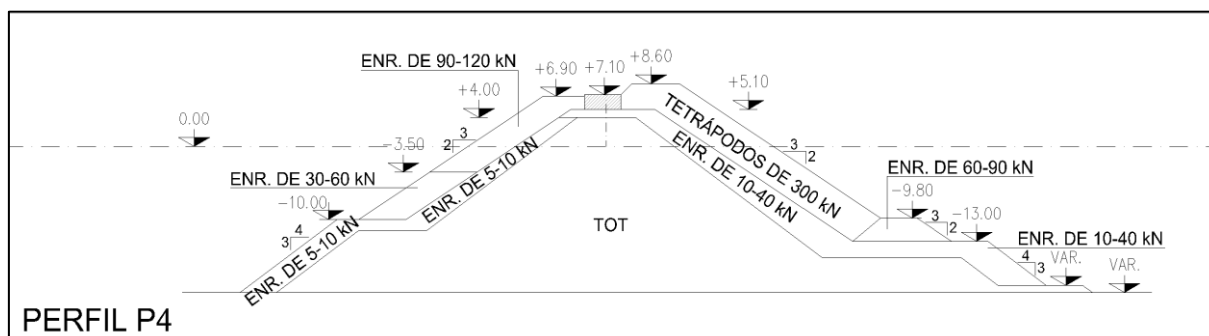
Perfil Transversal Tipo P4, construído em 1985
